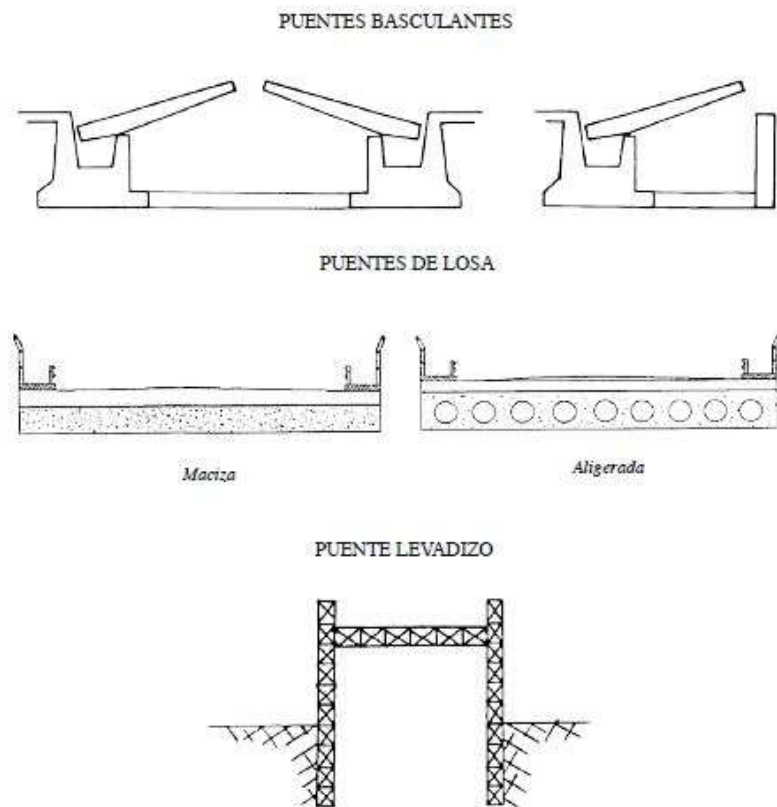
Detalles puentes basculantes, de losa y levadizo
